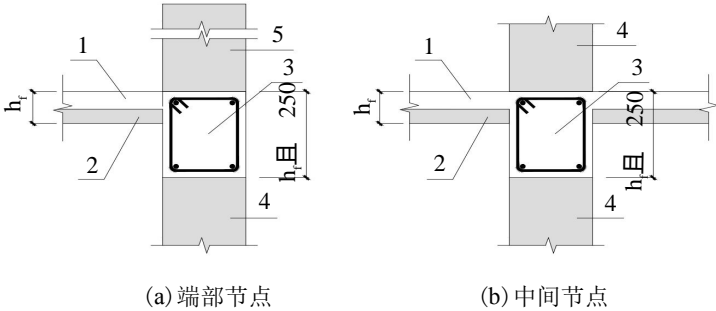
后浇钢筋混凝土圈梁构造示意
